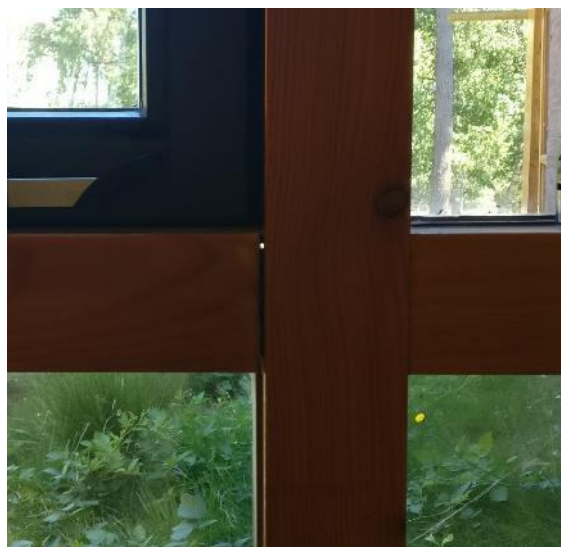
Op een enkele plek stond de kozijnverbinding helemaal open tot buiten. Waarschijnlijk door een bouwkundige fout.
